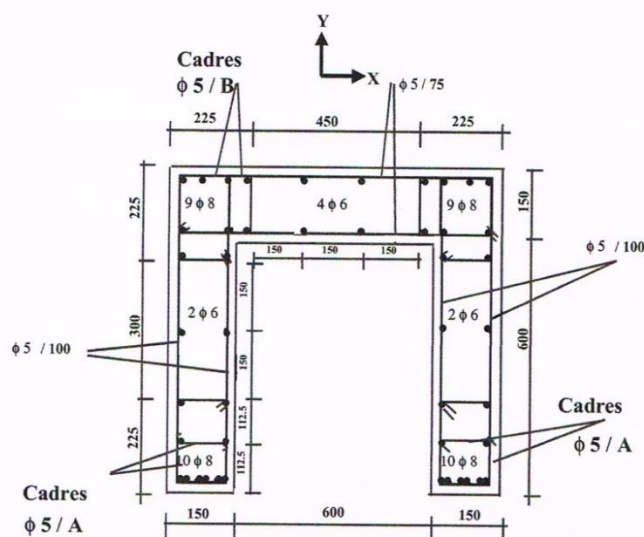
Schéma type du ferrailage des voiles testés sur table vibrante
